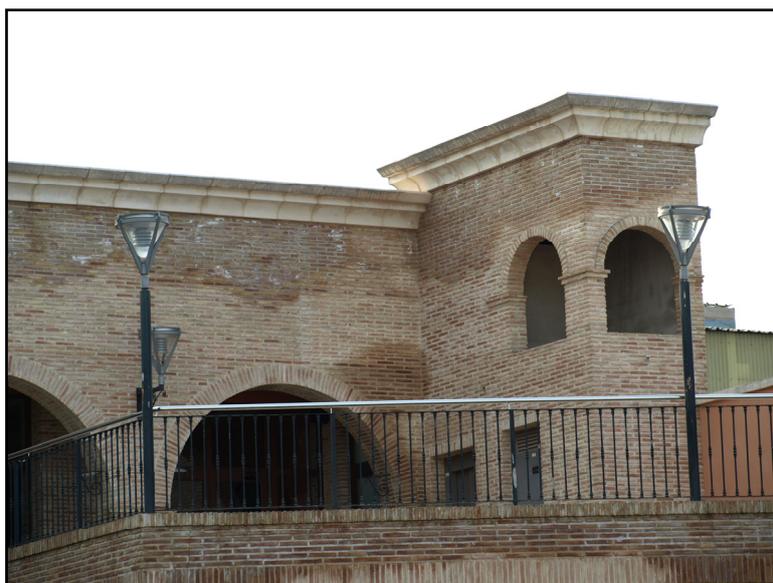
Fachada de ladrillo con manchas de humedad, y eflorescencias. Restaurante Ranga II. Carretera de Fortuna (Murcia).
